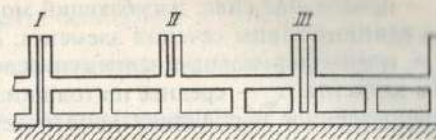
Схема разрезки подводного массива здания ГЭС постоянными поперечными швами: I — сквозной разрез; II — разрез до верха перекрытия отсасывающих труб; III — разрез до фундаментной плиты
